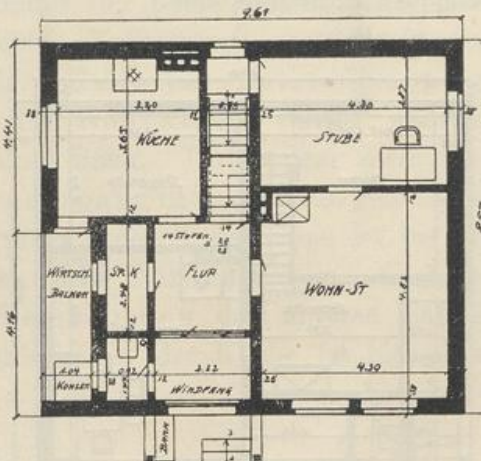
Bürgerliches Wohnhaus. Treppe von der Stube zugänglich, Abort vom Windfang. Wirtschafts-lau-be. Dachgeschoß voll ausgebaut.
